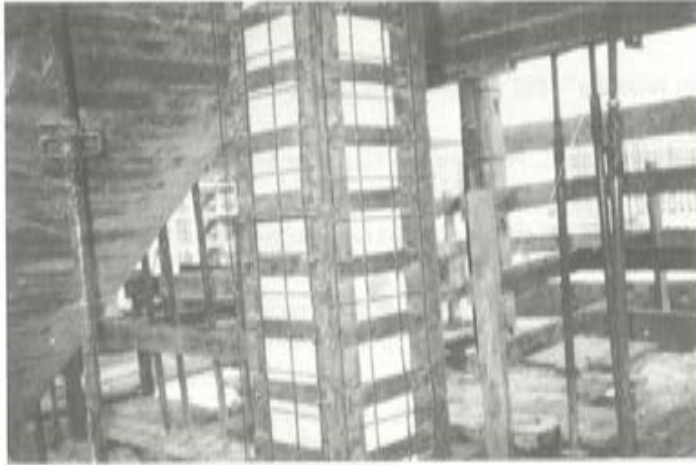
En esta fotografía se puede ver el empresillado metálico correspondiente a un zunchado paralelepédico de un pilar, que posteriormente quedó embebido en un recrido de hormigón Prepakt de 5 cm de espesor total.
